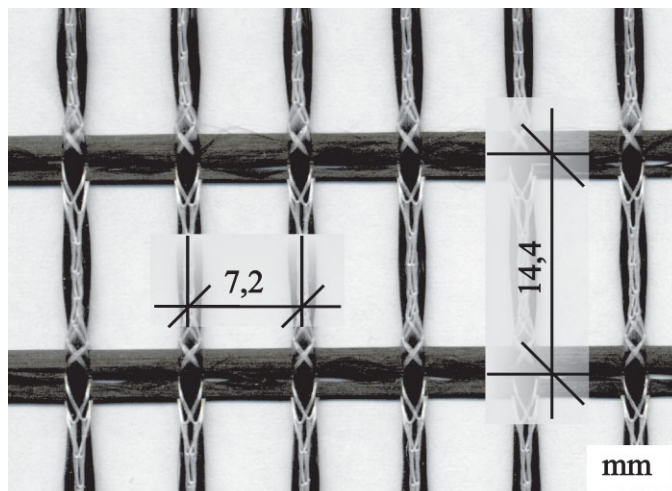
Textiles Bewehrungsgelege NWM3-006-08-b1 (15%)
